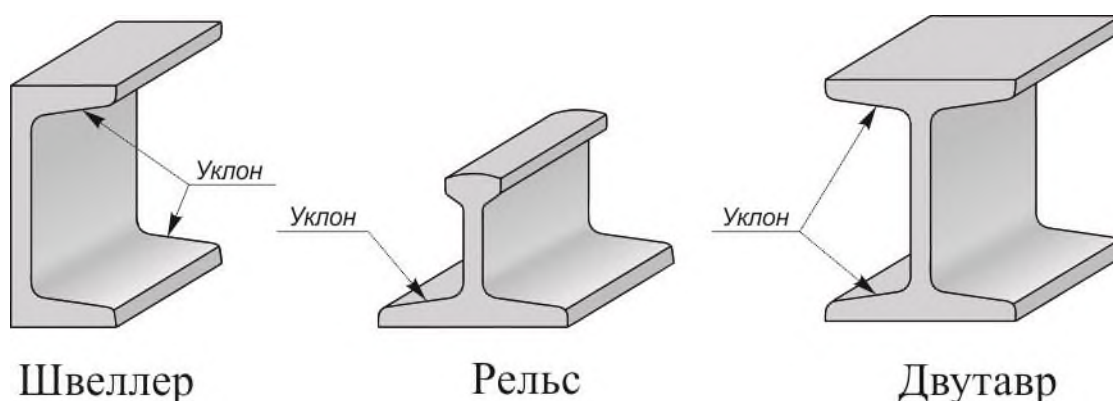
Стальной фасонный прокат для металлоконструкций
